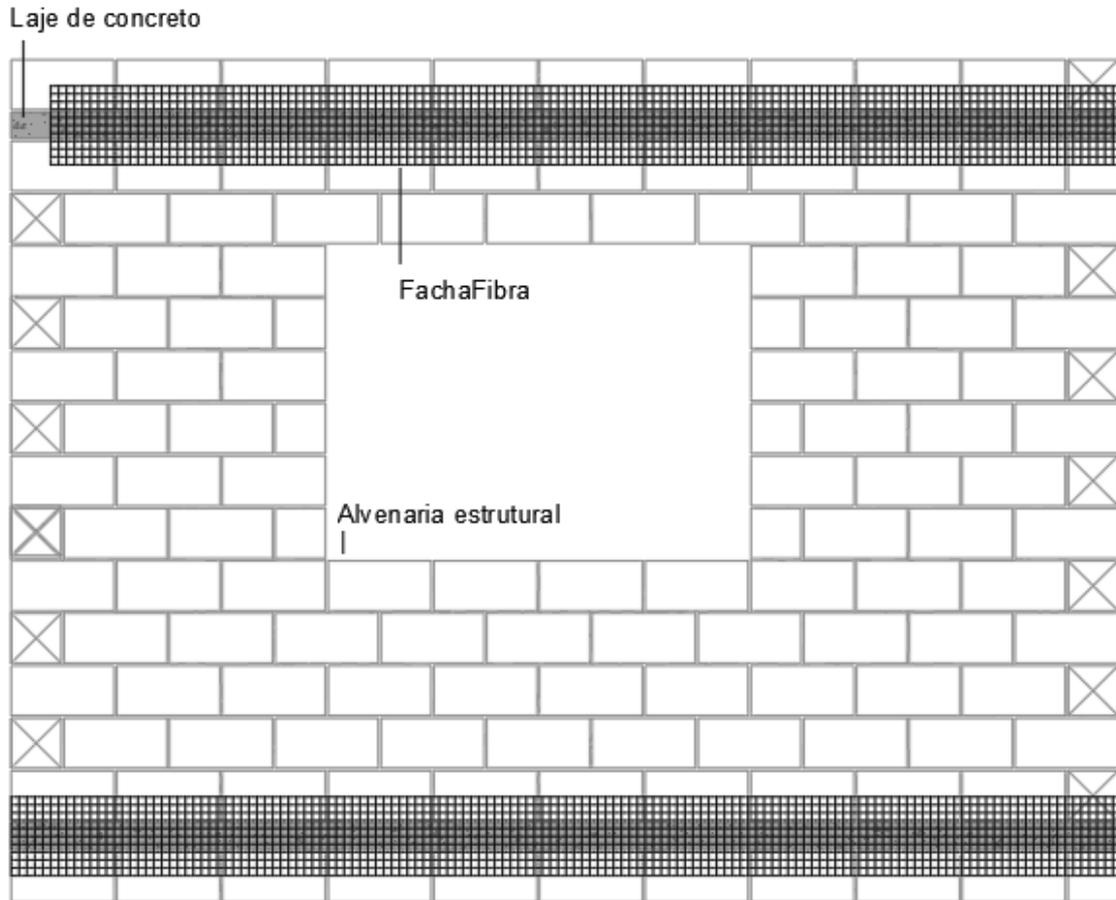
Posicionamento da FachaFibra para reforço do revestimento de argamassa nas interfaces entre alvenaria estrutural e laje de concreto armado
